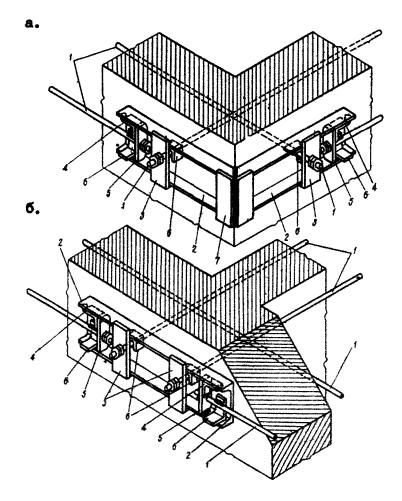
Схемы усиления покольного пояса стен парными стальными тяжами и устройства обжимных элементов:
